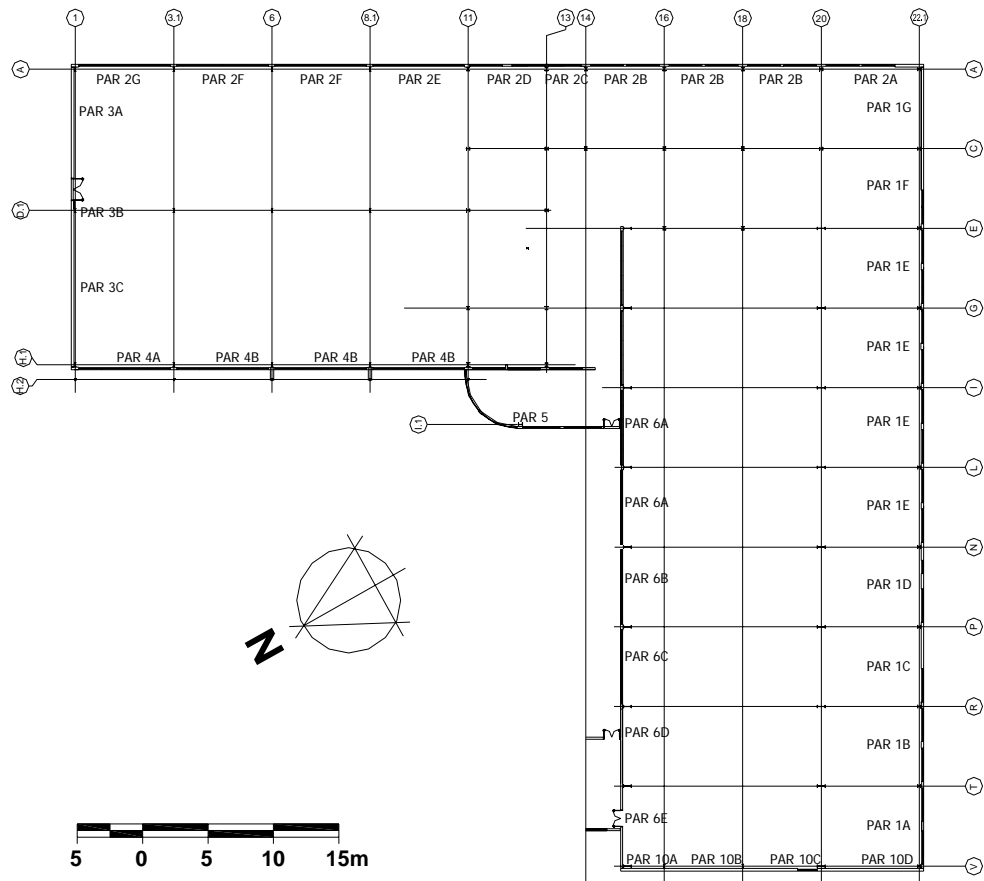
Planta baixa esquemática do projeto de alvenaria do Edifício LBE.
